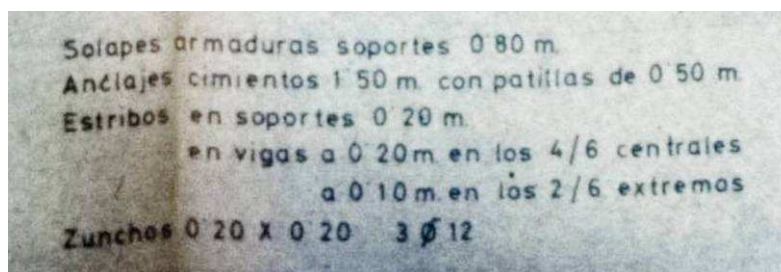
Leyenda de plano de estructura. Edificio ficha 236C.008, 1972.
